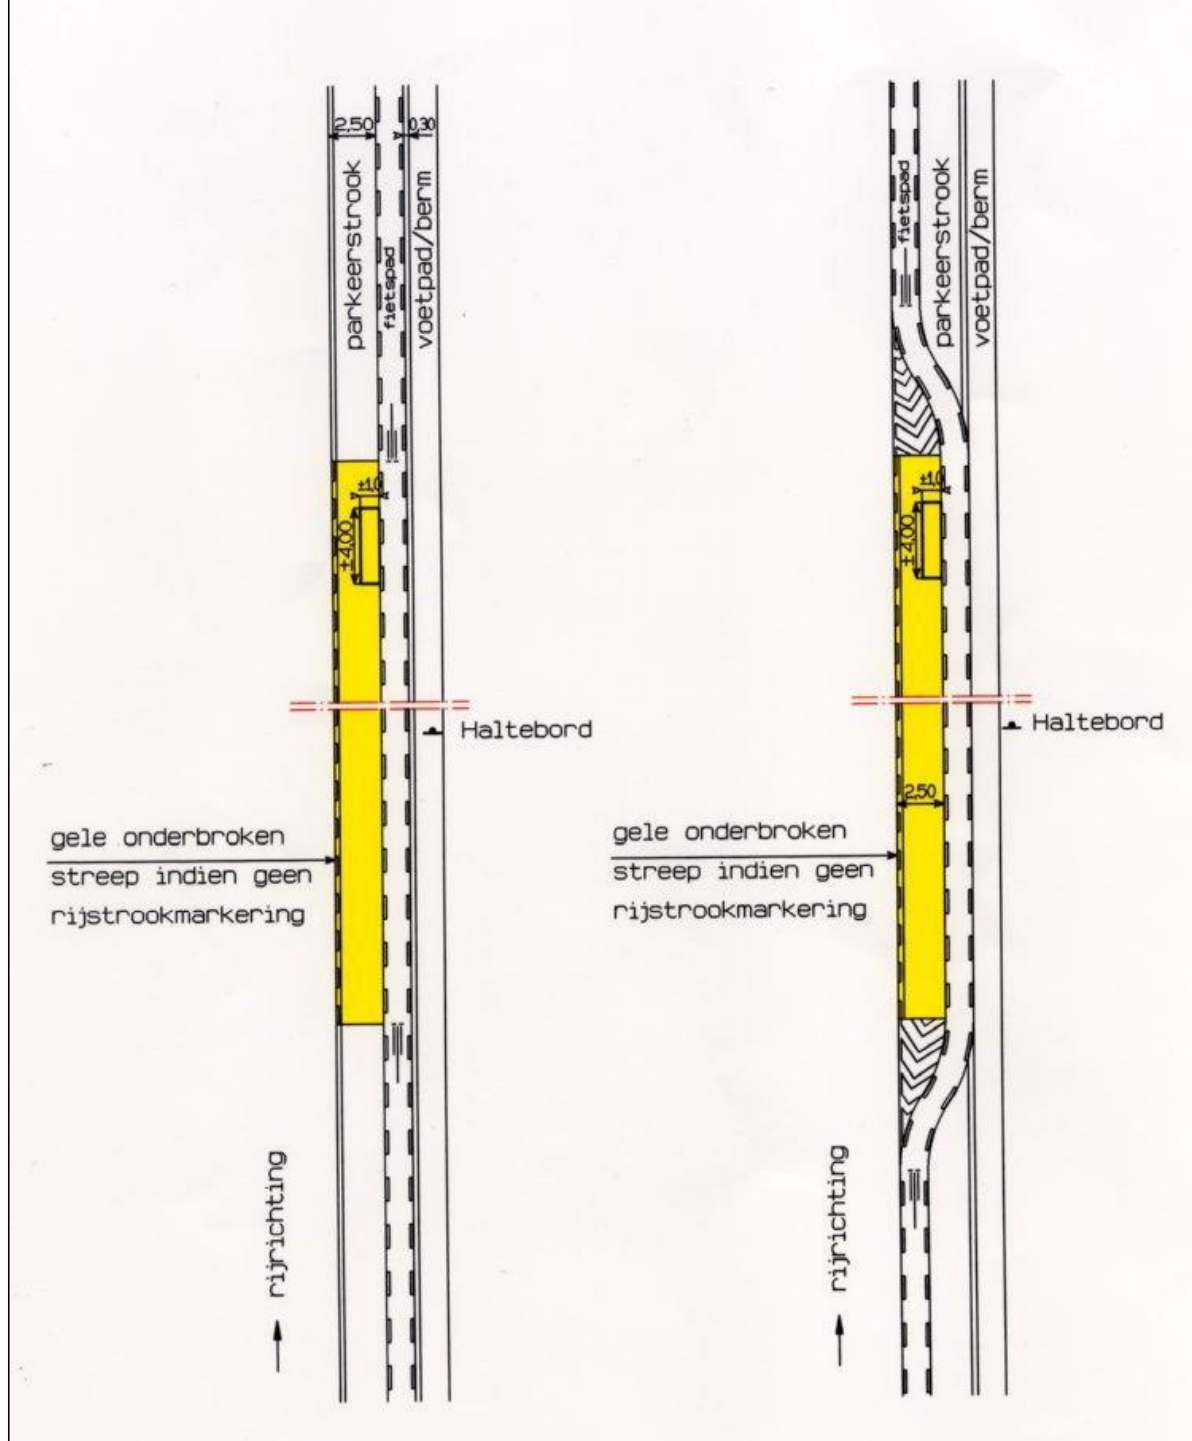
Detail halte buiten rijbaan – met voor- of achterliggend fietspad
